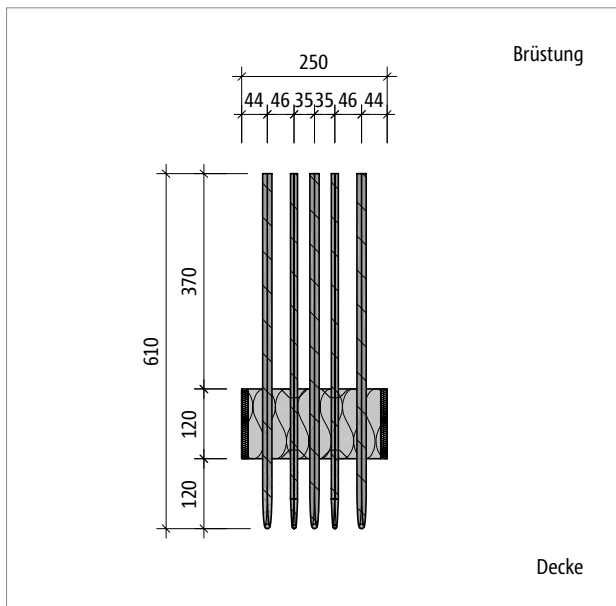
Schöck Isokorb® XT Typ AP: Produktschnitt
